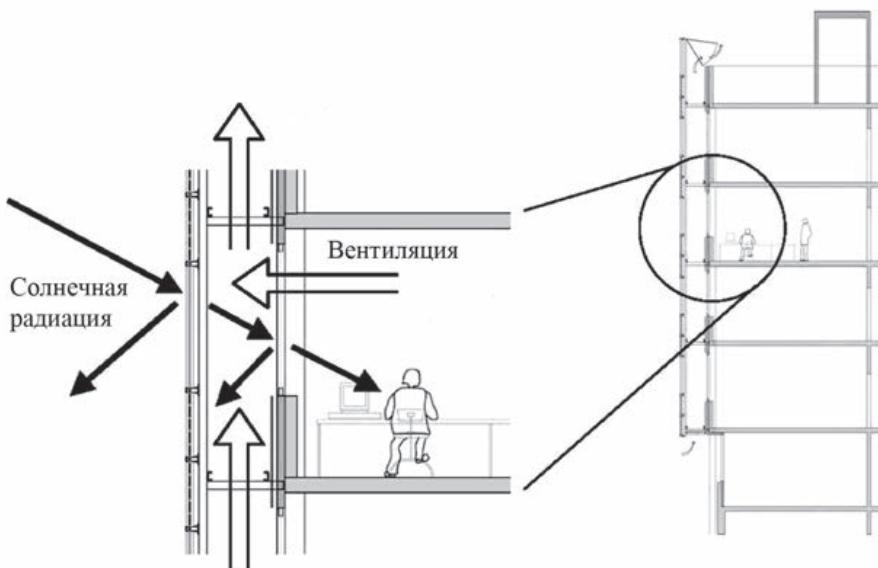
Общая концепция двойного стеклянного фасада — создание буферной зоны между основной светопрозрачной оболочкой здания и наружной средой [11]
